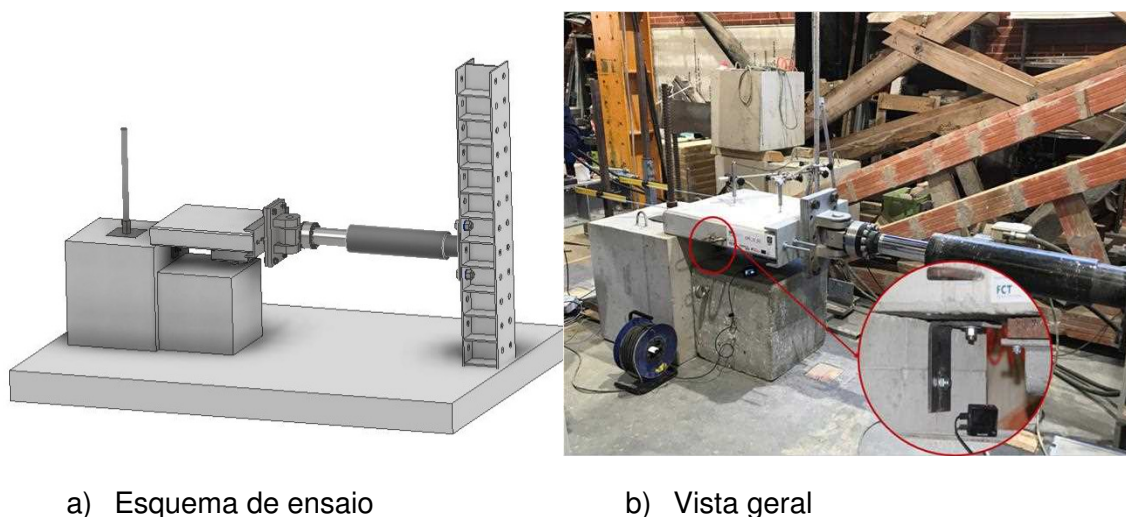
Setup de ensaio no plano de ligações painel-pilar.
